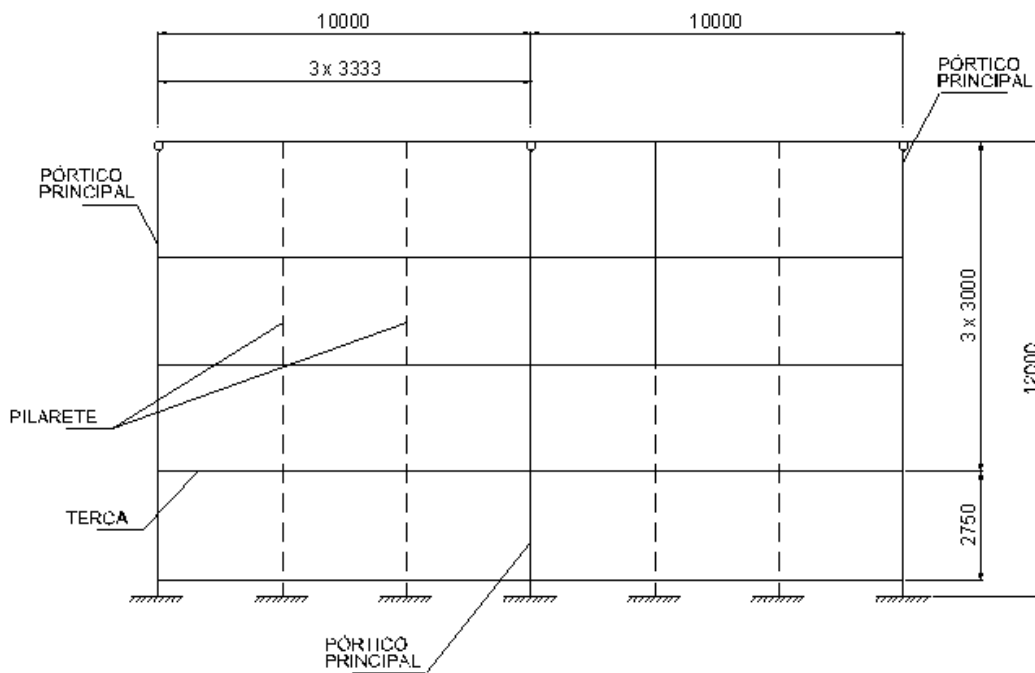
Vista de parte da estrutura de fechamento lateral dimensões em milímetros.
